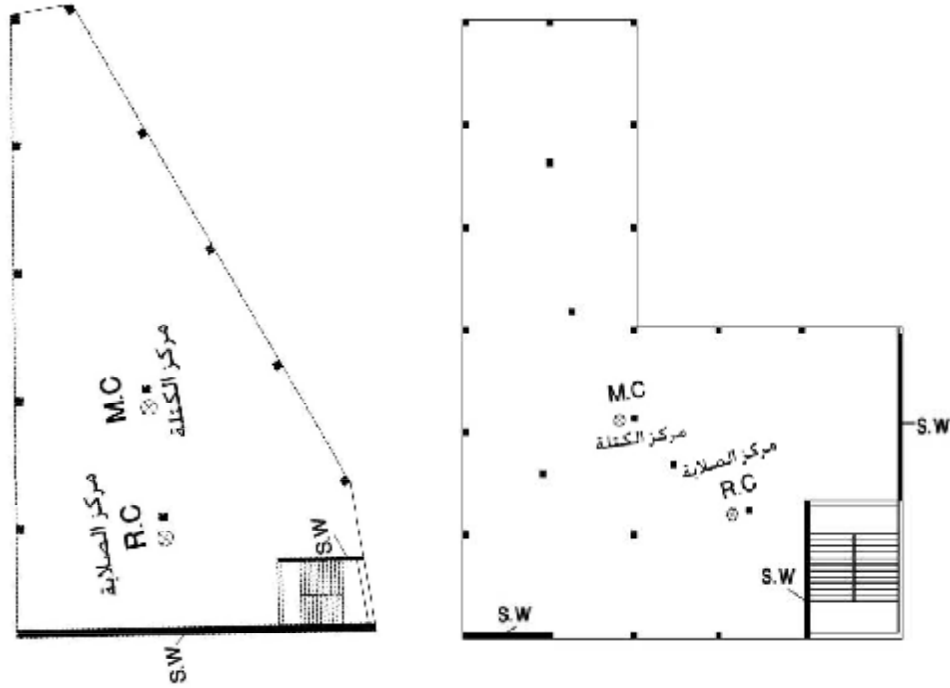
بعض الحلول الهندسية للمباني ذات الأشكال المركبة
